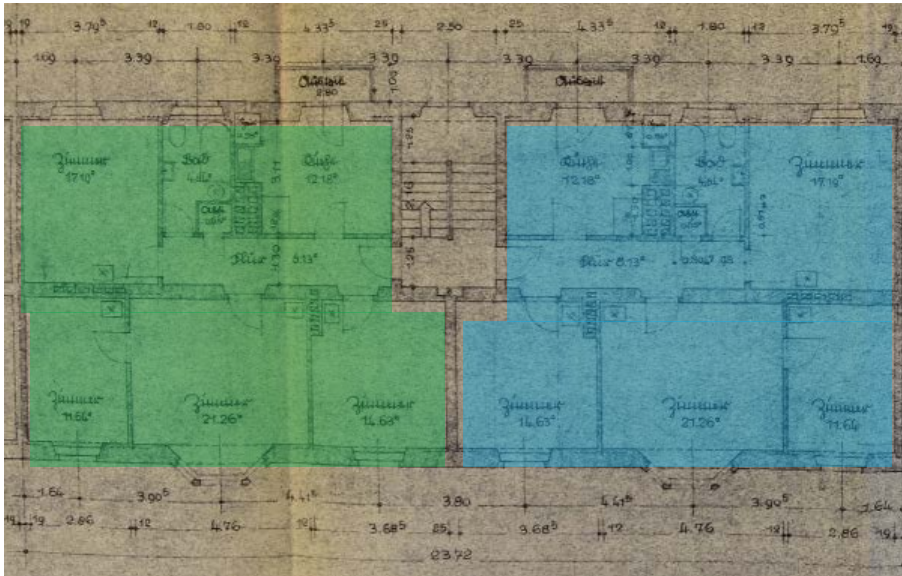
Grundriss eines Wohngebäudes von 1941<sup>132</sup>
